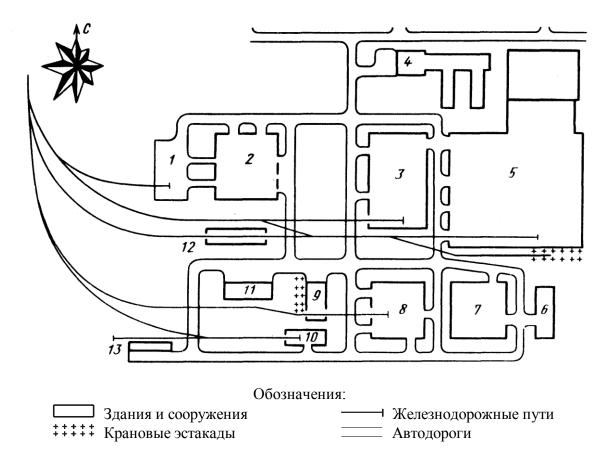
Схема генерального плана станкостроительного завода [1]: 1 — склад лесопиломатериалов; 2 — деревообрабатывающий корпус (с тарным цехом); 3 — корпус тяжелых станков; 4 — инженерно-лабораторный корпус; 5 — главный корпус (с термоконстантным цехом); 6 — склад узлов и запчастей; 7 — корпус вспомогательных цехов; 8 — корпус заготовительных цехов; 9 — склад металла и заготовок; 10 — склад отливок и поковок; 11 — главный магазин; 12 — склад готовой продукции; 13 — склад горюче-смазочных материалов
